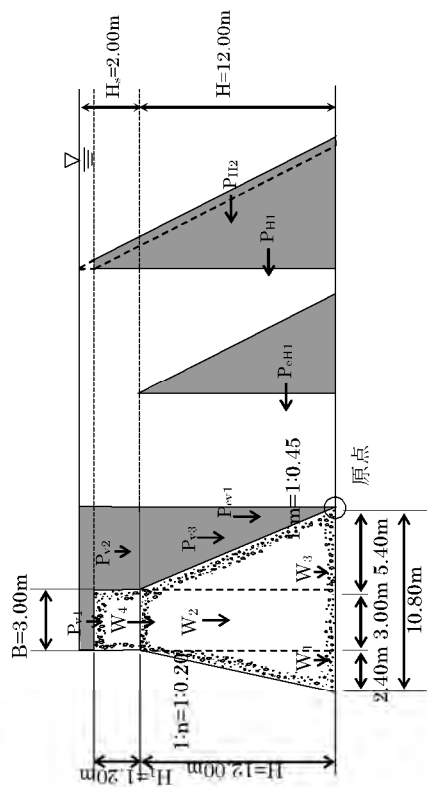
砂防堰堤に作用する力 (断面 (1) : 土石流捕捉後の湛水時)
